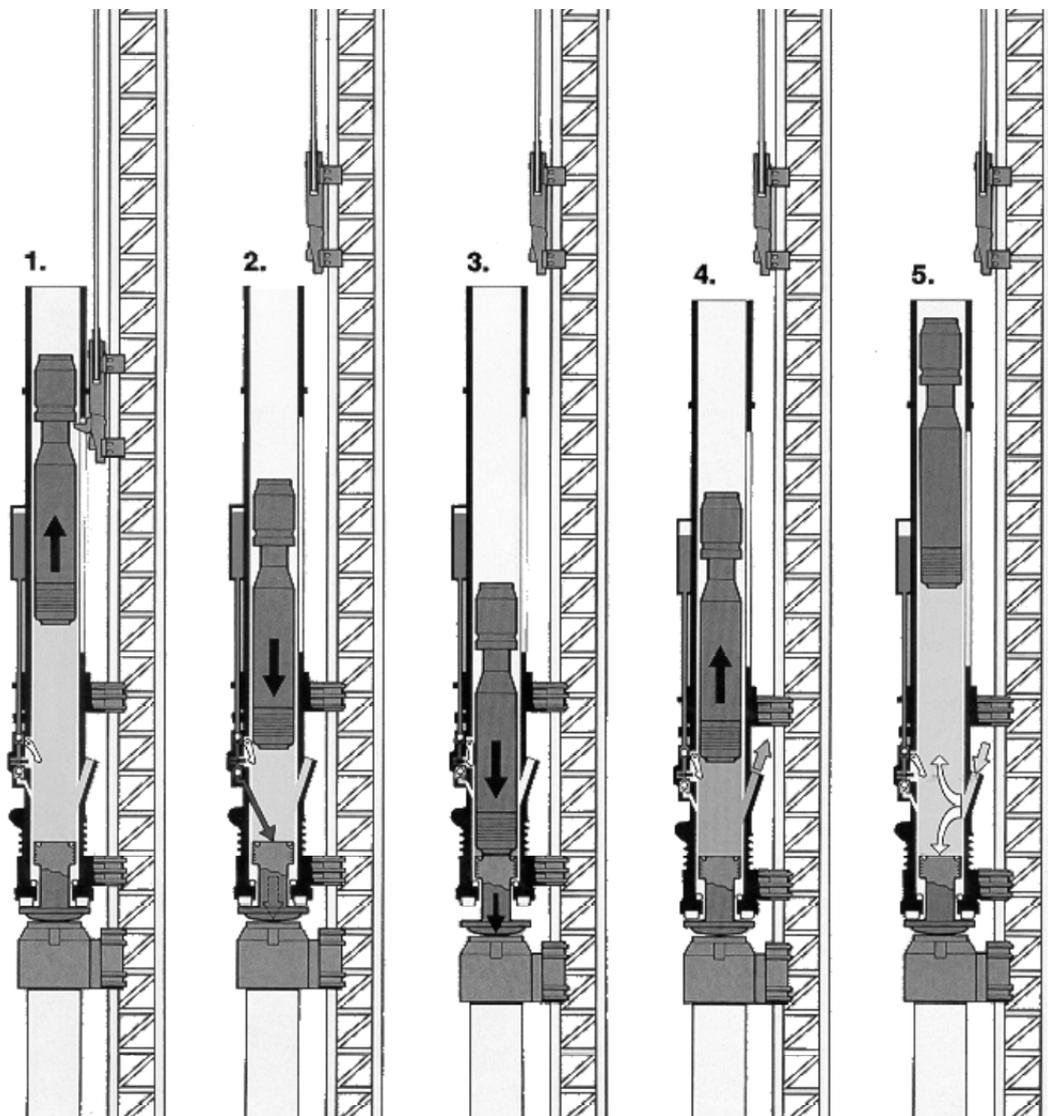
Dieselnär DELMAG System (Explosionsbär) [2]
